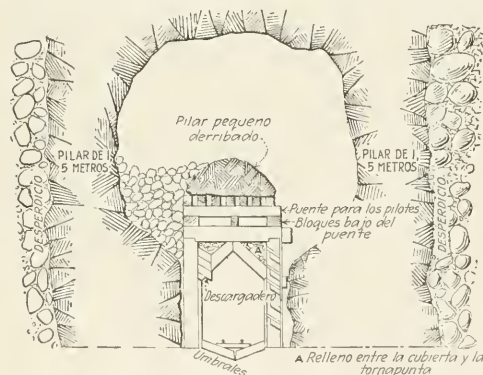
Detalles del ademe de madera de una sección de excavación abierta en una galería inferior de pilares.
